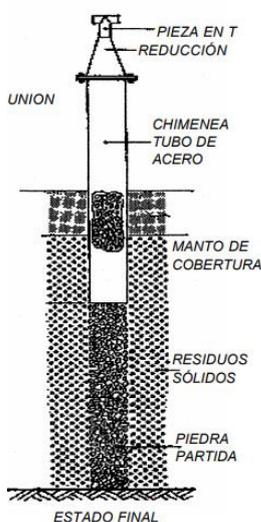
chimenea para vertedero. Fuente: Proyecto Universidad Nacional de Córdoba.
